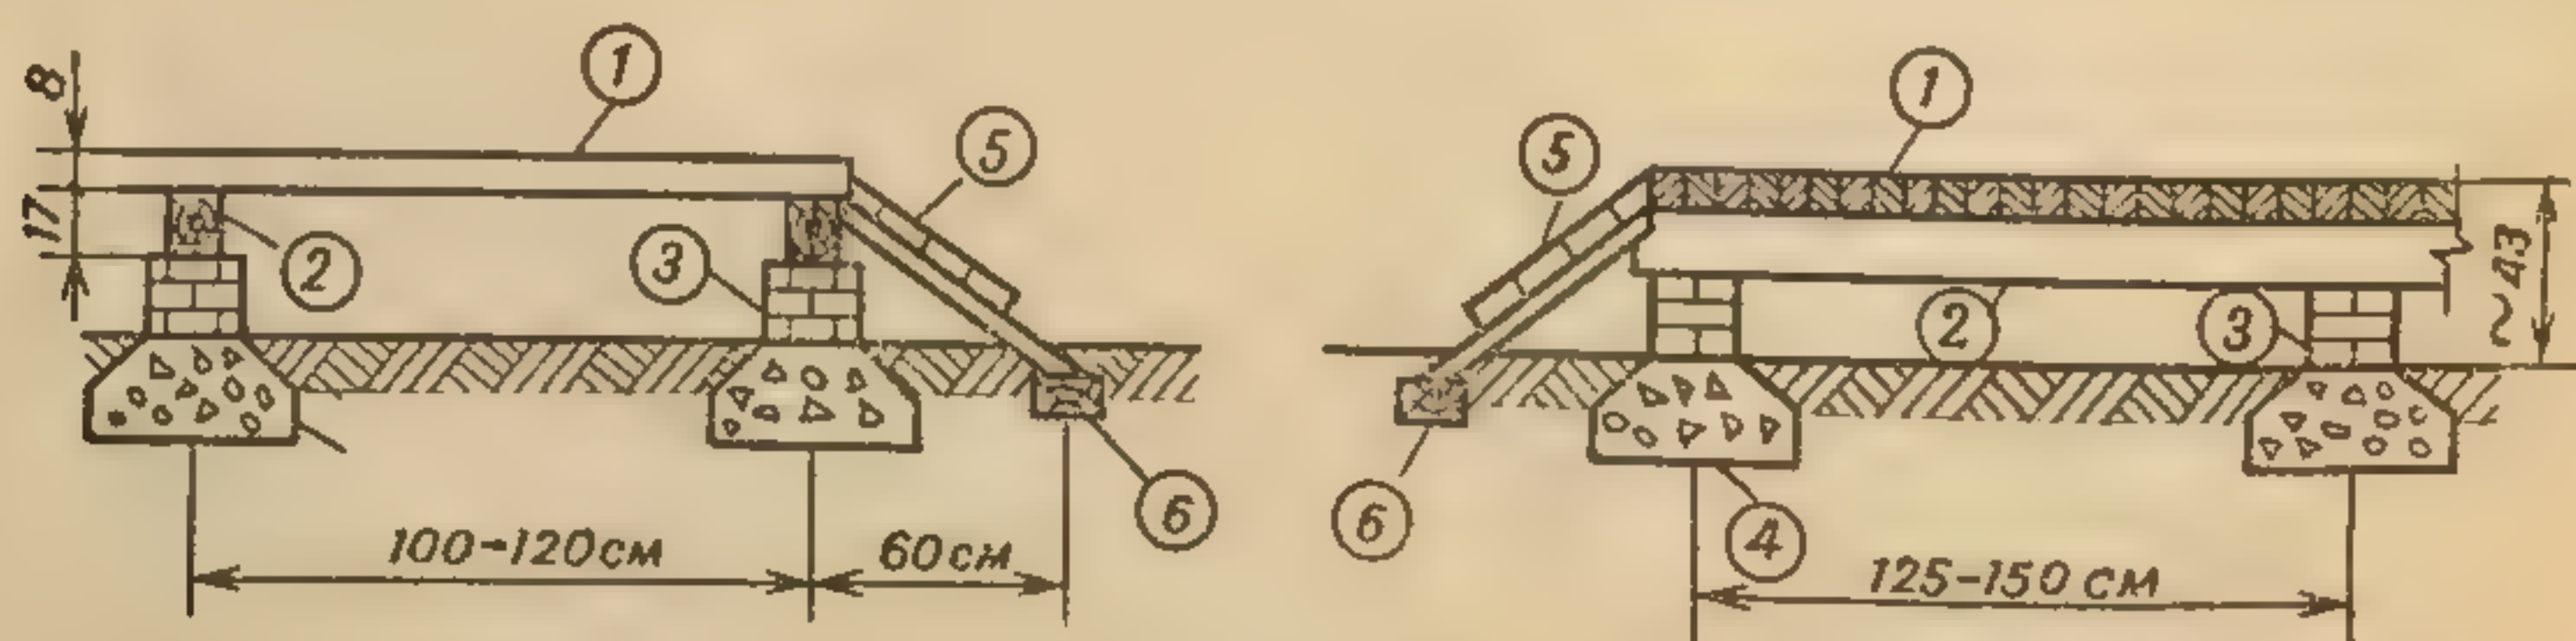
Конструкция спортивной площадки с деревянным настилом:
